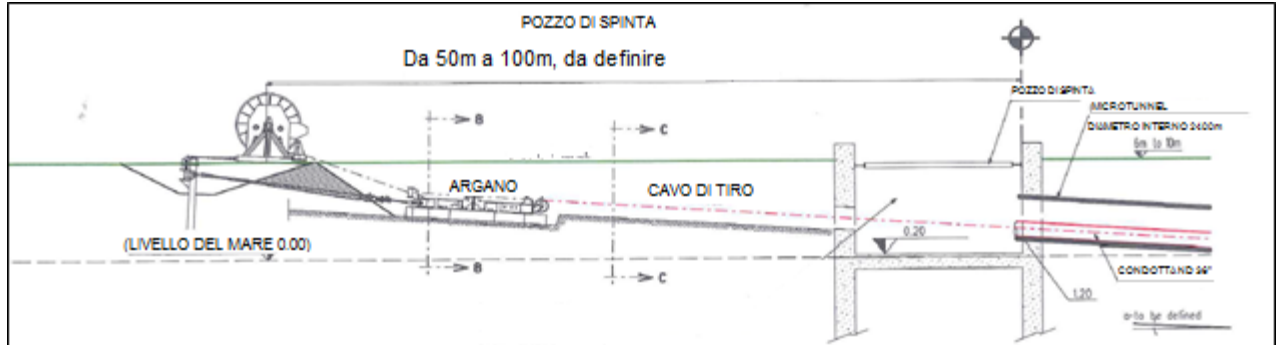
Foto di un esempio di collegamento all'argano su rampa inclinata
